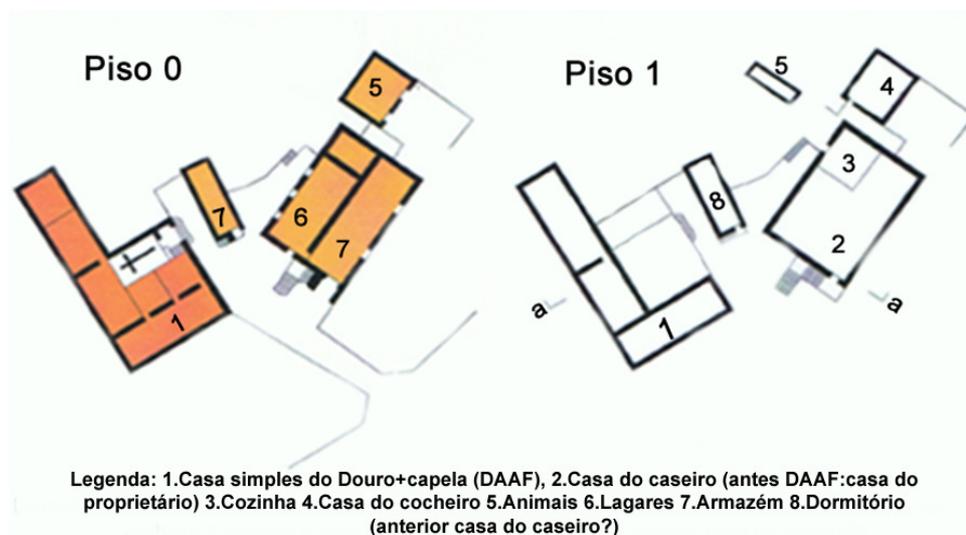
Planta da Quinta das Nogueiras (retirado de [4])
